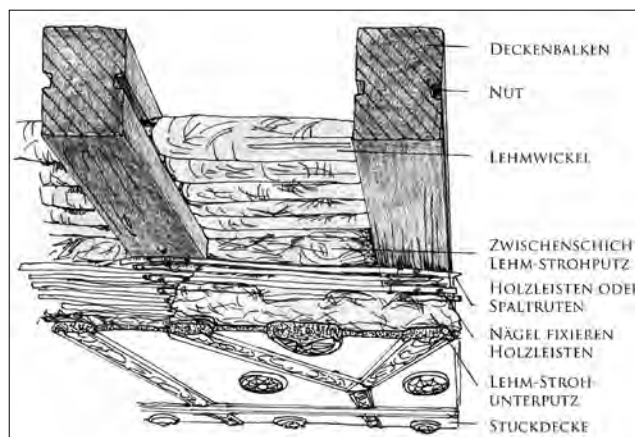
Beichlingen, Hohes Haus, Rekonstruktionszeichnung zum Deckenaufbau der verlorenen Modelstuckdecke im zweiten Obergeschoss
